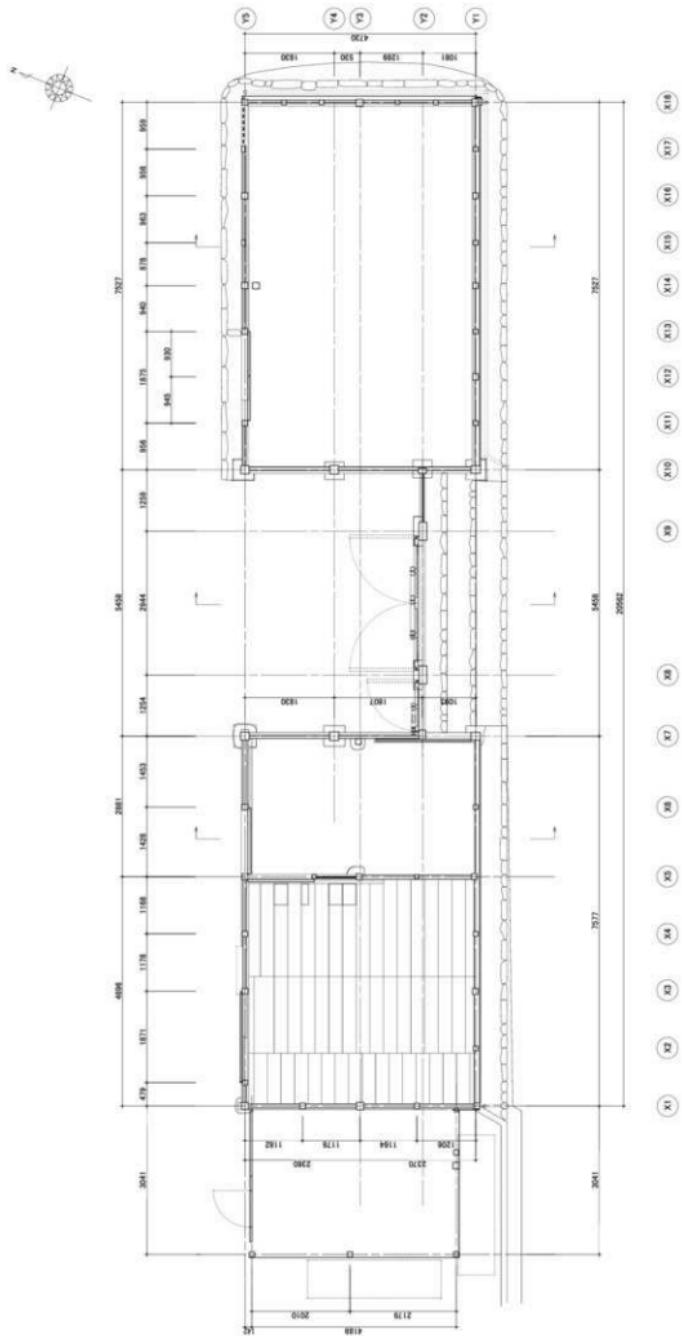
長屋門 修理前 1階平面図 S=1/100
